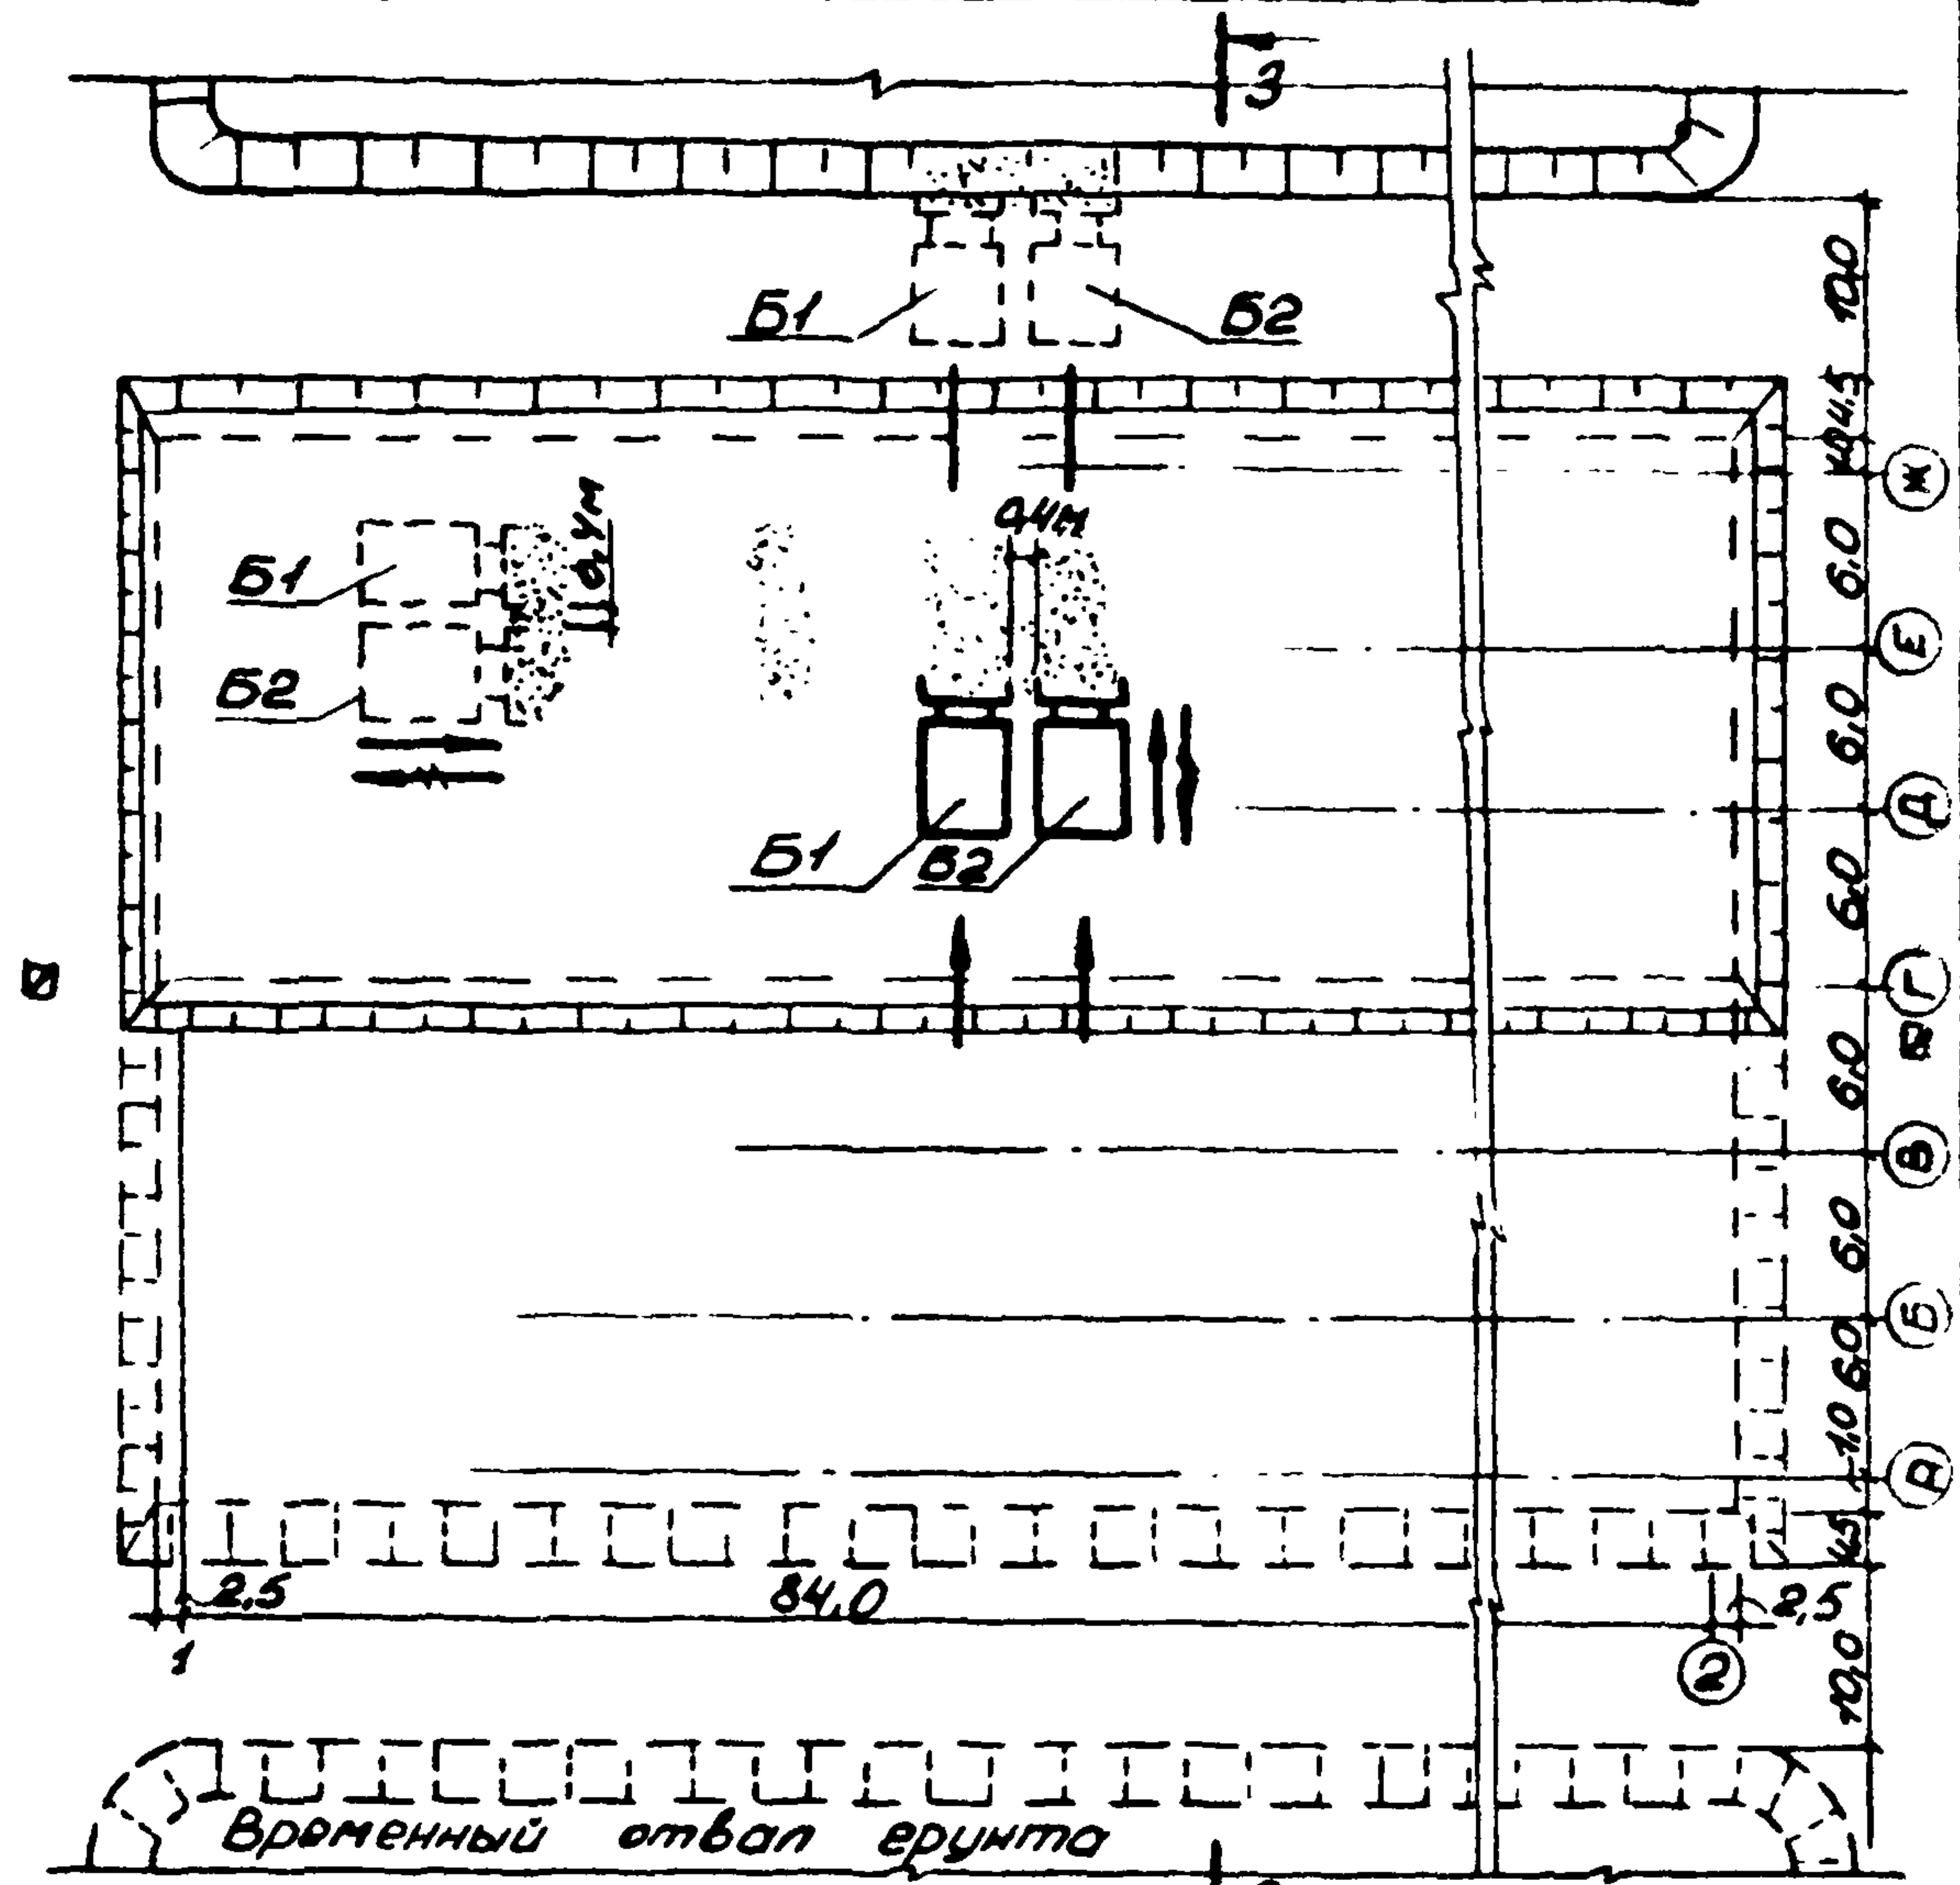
Схема разработки и перемещения грунта траншейным способом.
